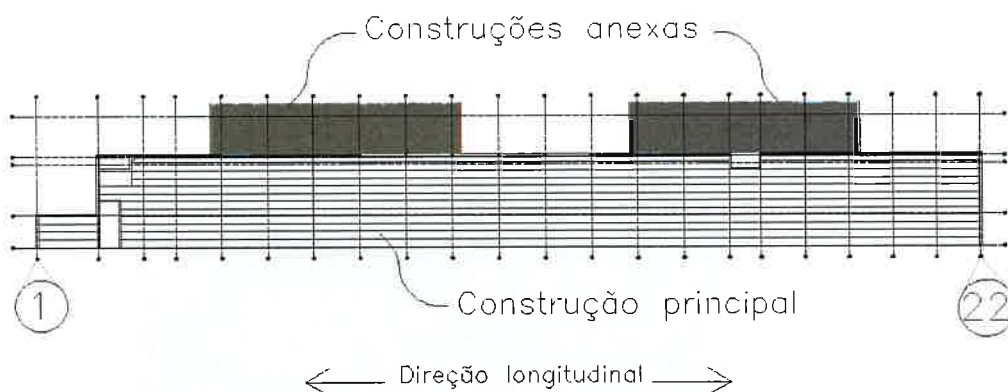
Planta da Edificação 5 – Região de arquibancadas.
